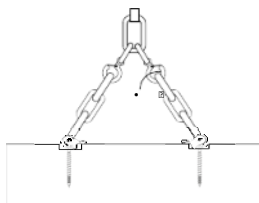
Chargement purement axial de la vis grâce à des fraisages précis
